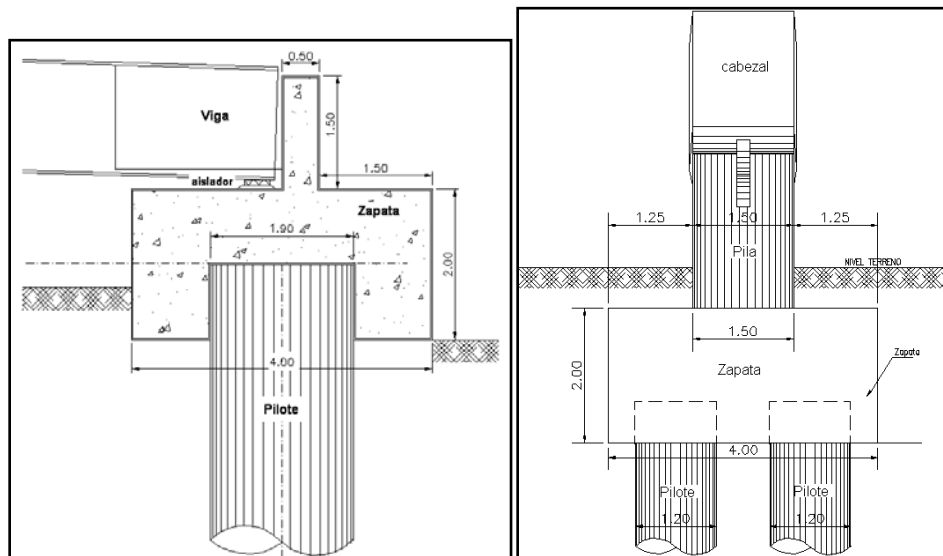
Vista en planta de Zapata Pila 44, 45 y 46. (CEE, 2008)
